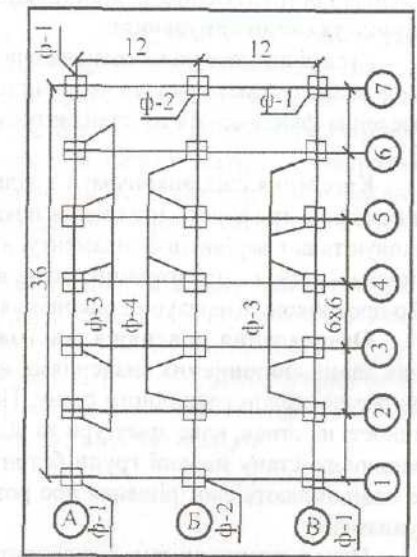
План фундаментів для каркасного будинку: А-В – поздовжні (літерні) осі; 1-7 – поперечні (цифрові) осі; ф-1...ф-4 – конструктивні типи фундаментів
